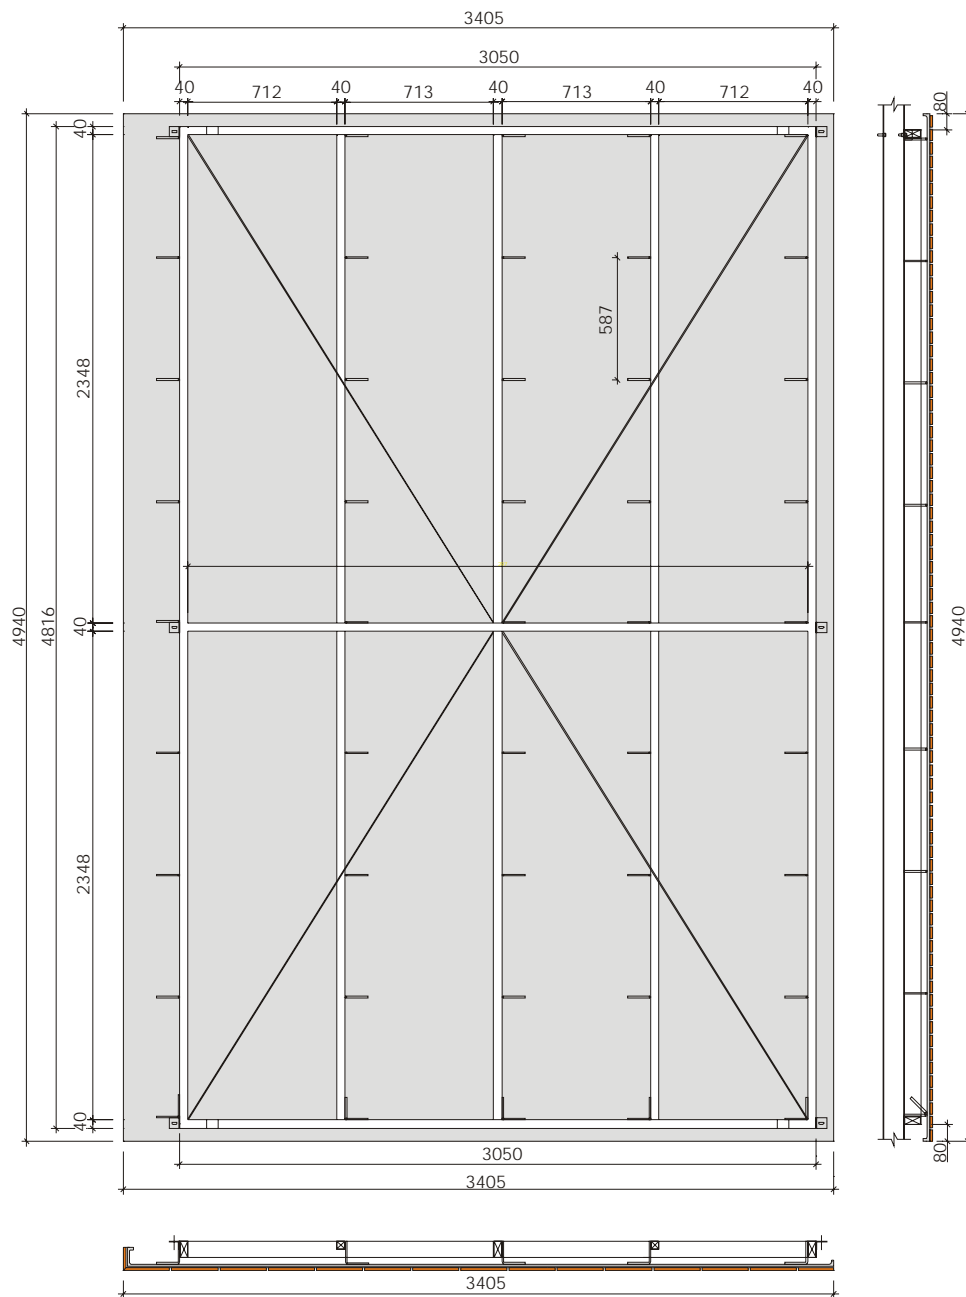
Vista posterior e corte transversal do painel B1 tipo *stud frame
